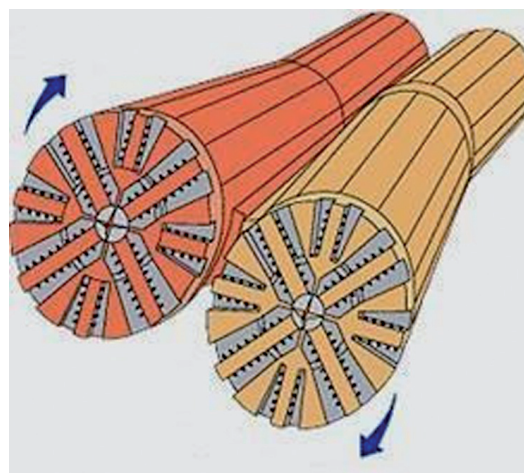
da [11] – Tunnel paralleli sullo stesso piano.
